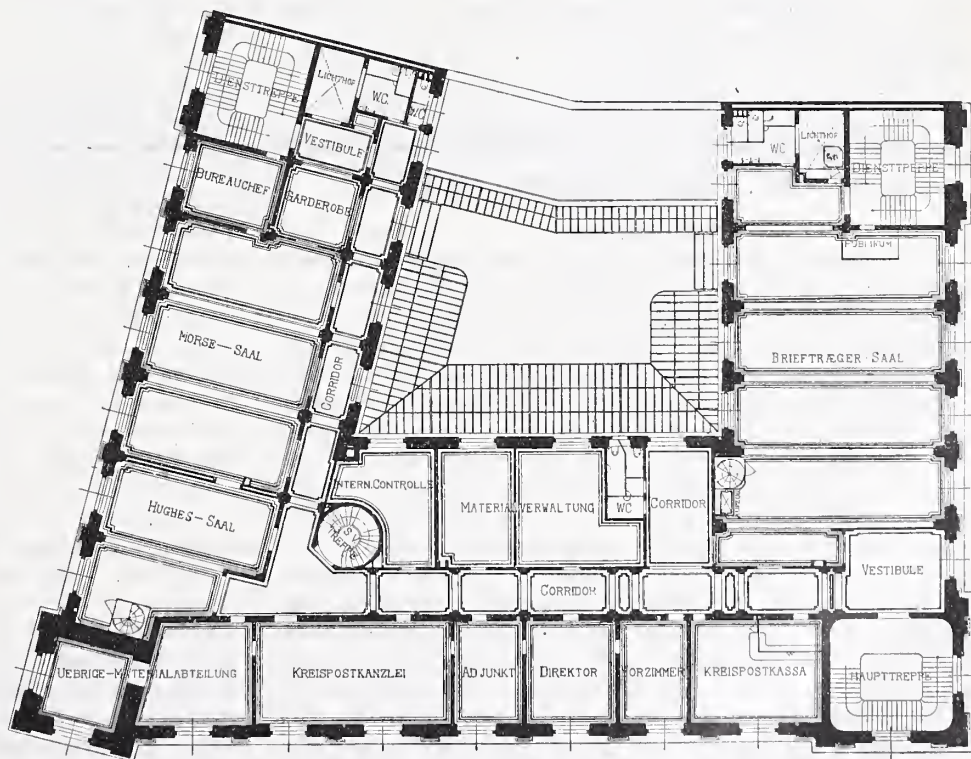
Grundriss vom I. Stock. — Masstab 1 : 500.
